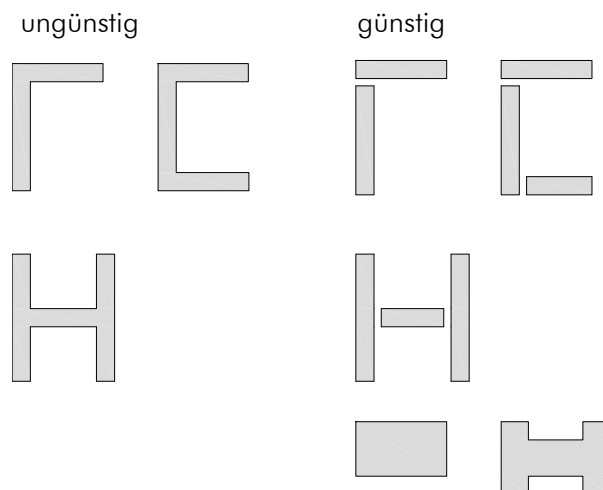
ungünstige und günstige Grundrissgestaltung [43]
